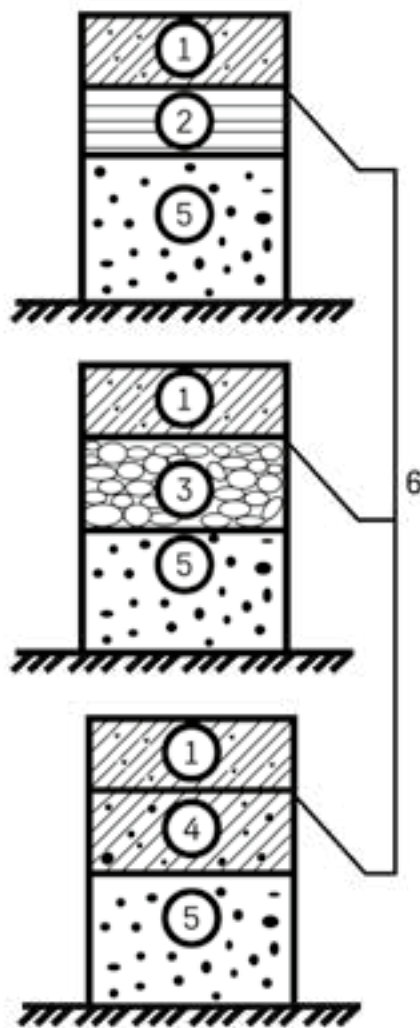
Типовые конструкции дорожных одежд с монолитным цементобетонным покрытием:
